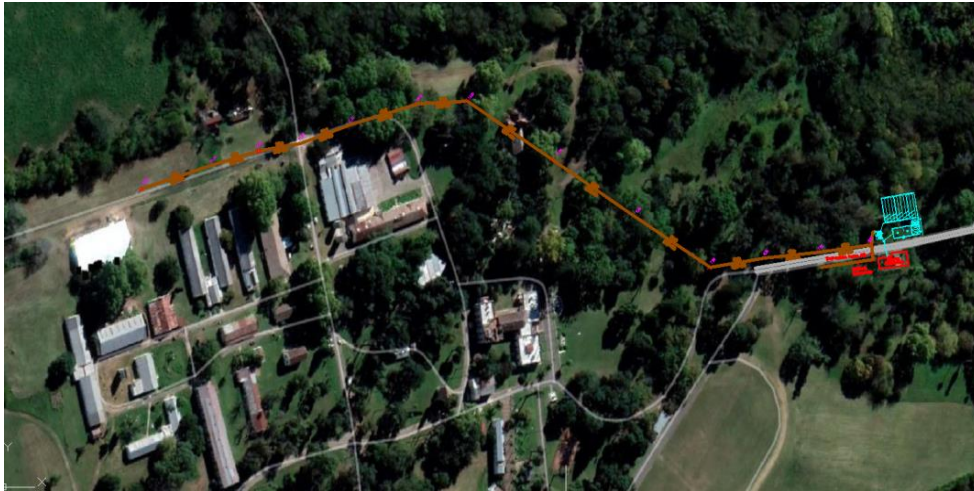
Traza de la nueva cañería hasta la planta de tratamiento proyectada.
